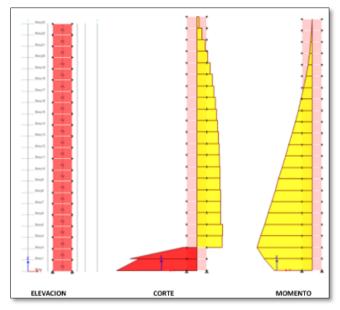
Detalle Elevación y Esfuerzos en Muros
